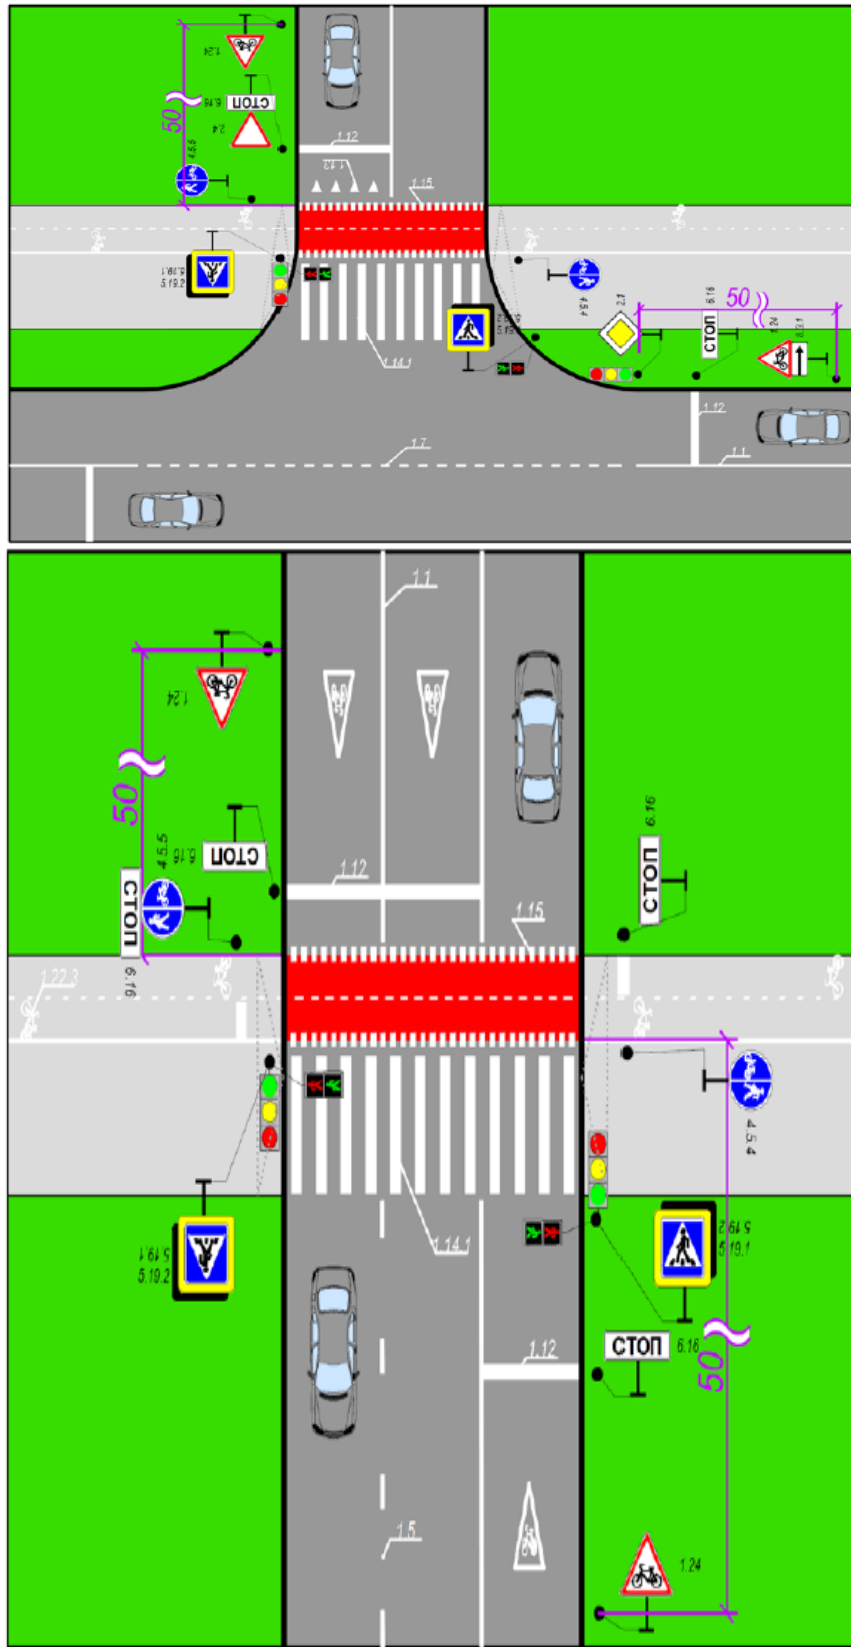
Варианты планировочного решения пересечения велополосой проезжей части дороги вне зоны перекрестка или в районе перекрестка в створе регулируемого пешеходного перехода
